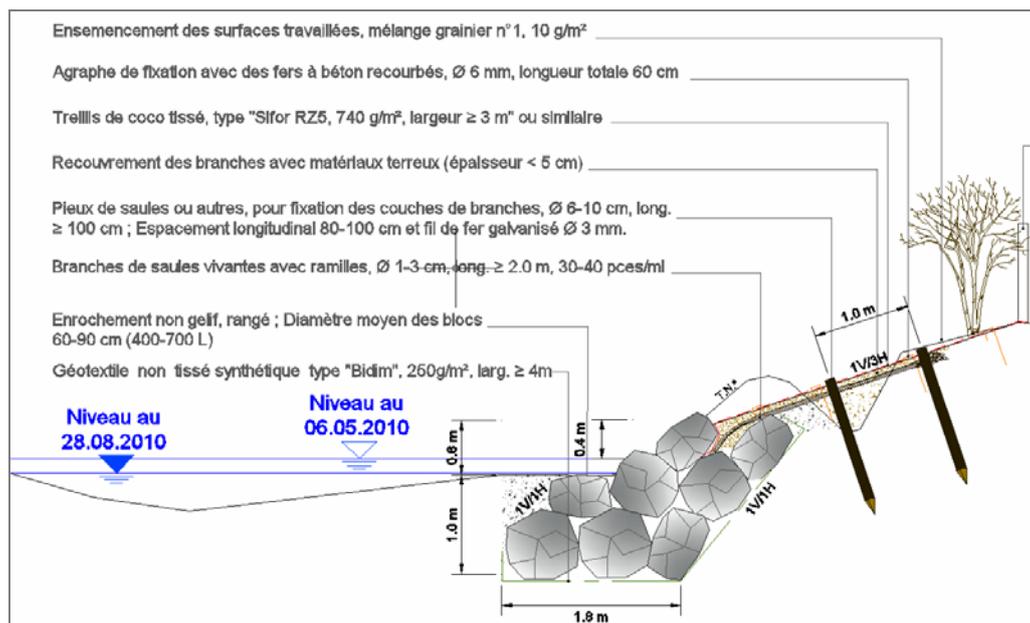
Couches de branches à rejets et enrochement de pied de berge.
